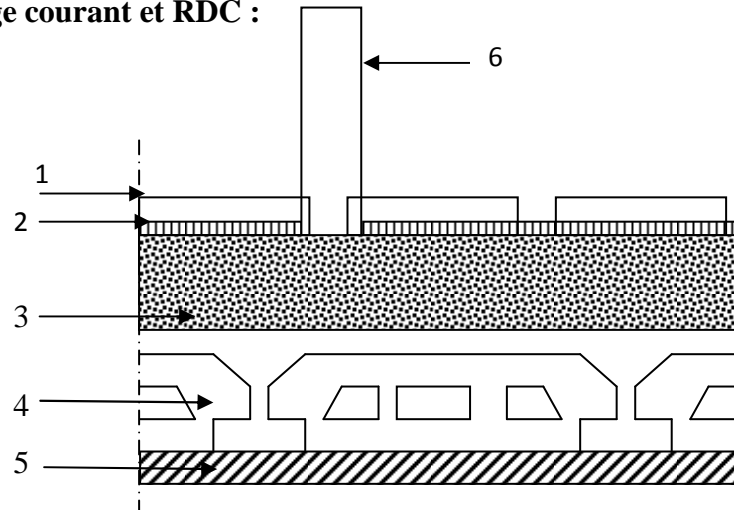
Coupe verticale du plancher étage courant et RDC.
